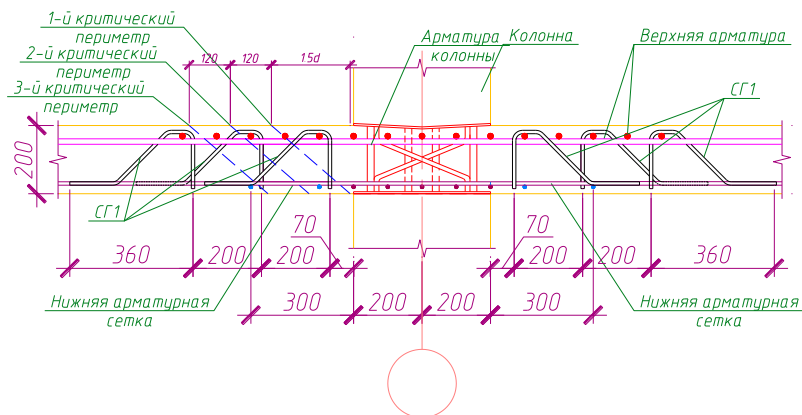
Вариант 2. Армирование монолитной плиты перекрытия в опорной зоне колонны с использованием в качестве поперечной арматуры гнутых стержней СГ1 из арматуры периодического профиля класса S500
